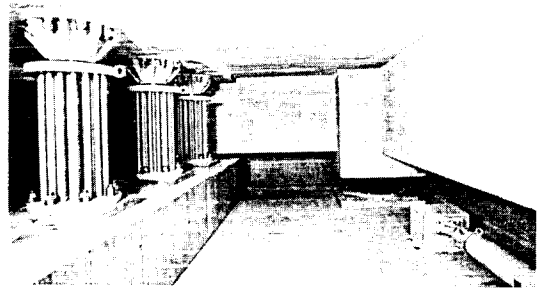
탄성중합체형(Rubber Bearing, Steel & Oil Damper)
